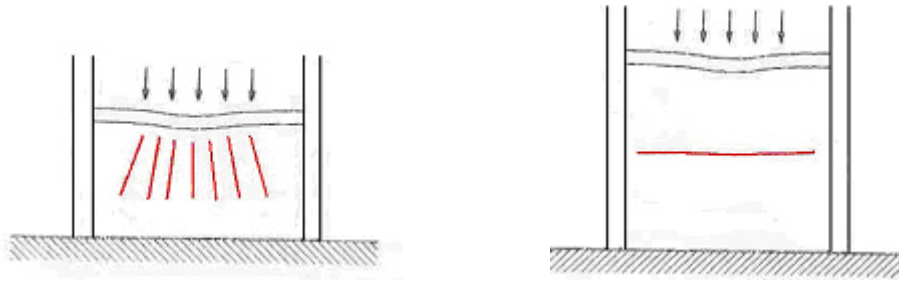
Fisuras en tabiques de planta baja (poca altura y esbelto).
